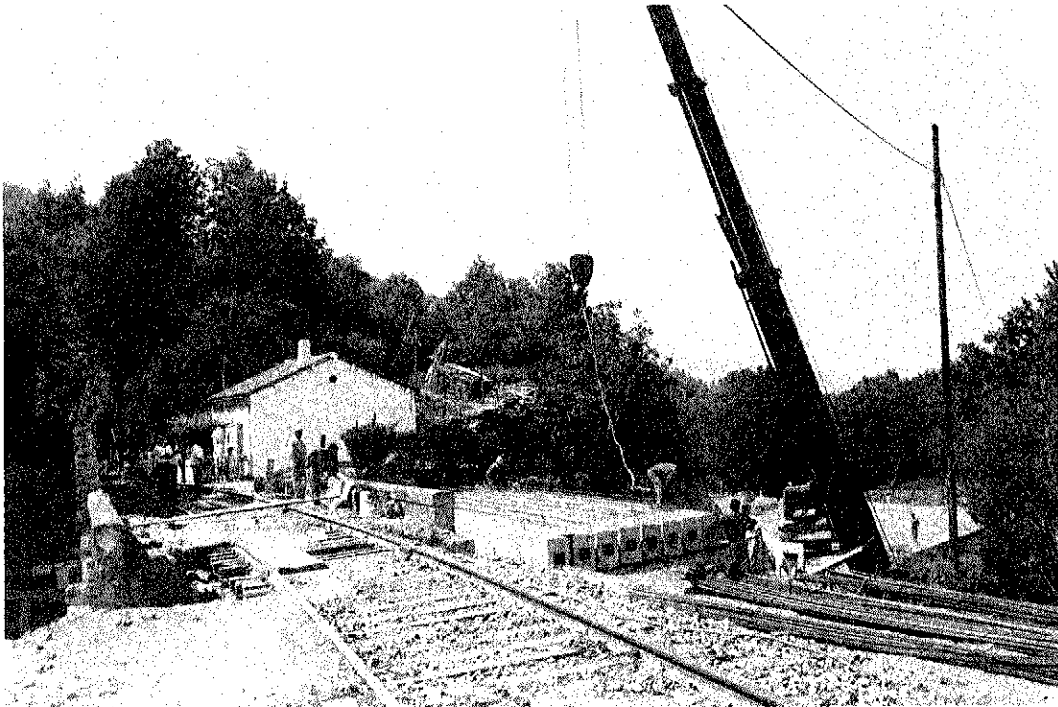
Colocación de las piezas prefabricadas que constituyen el tablero.
